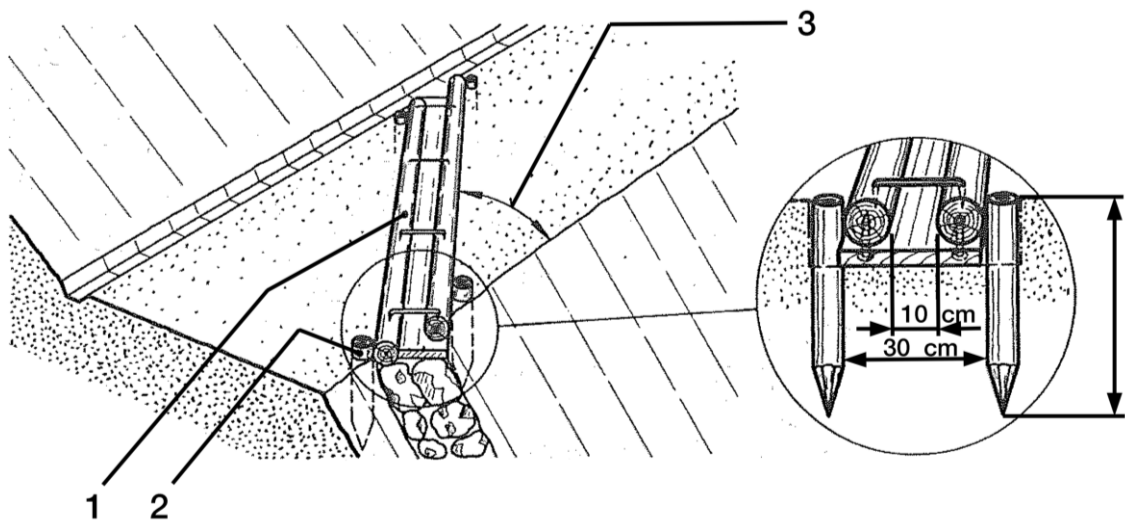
Weg mit Querrinne / Detail Holzrinne
